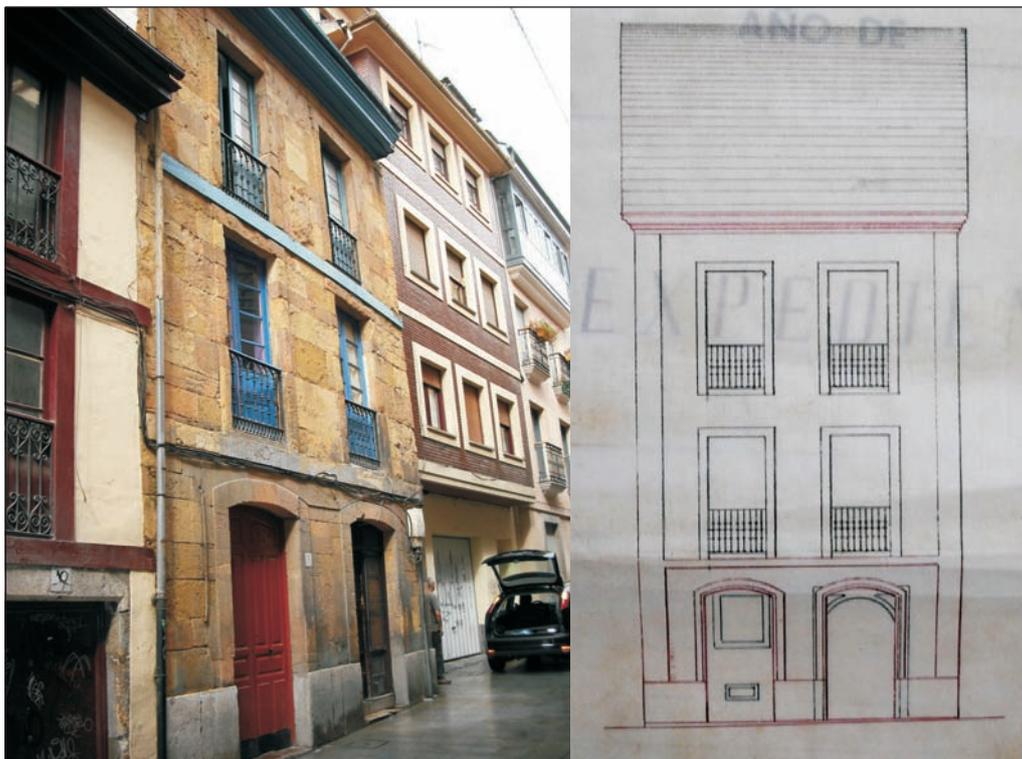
La casa nº 8 de la calle Santo Domingo y alzado de su reforma en 1879 (A.M.O.)
